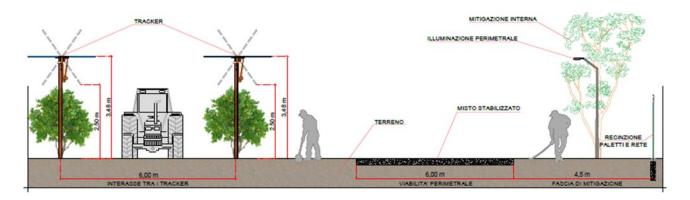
Visualizzazione schematica di una sezione di impianto. Sono visibili dettagli costruttivi (recinzione, opere di mitigazione e viabilità perimetrale).
